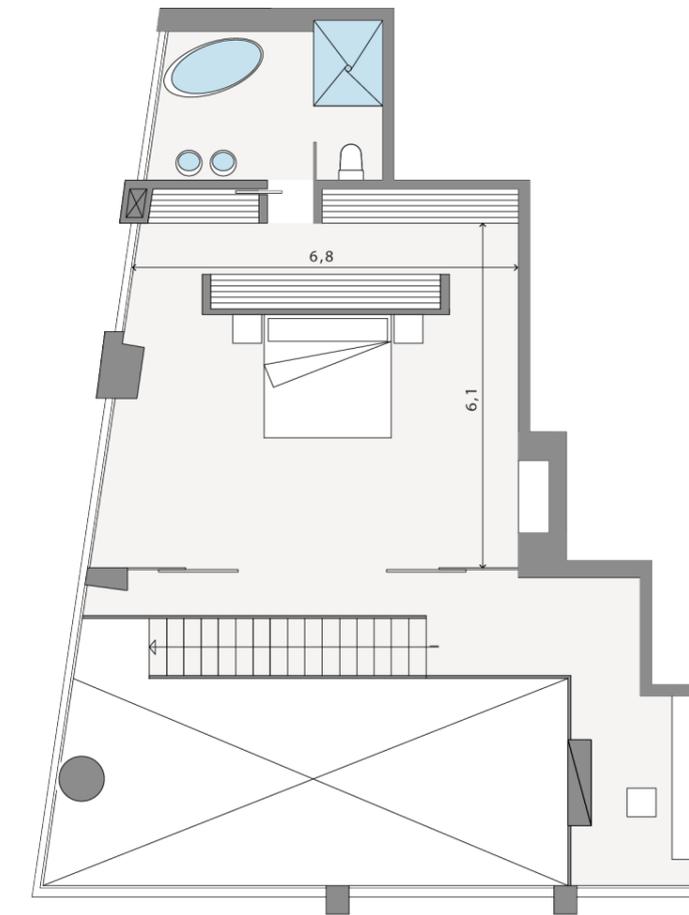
Planta Baja del Loft en el Mucman Tower.
